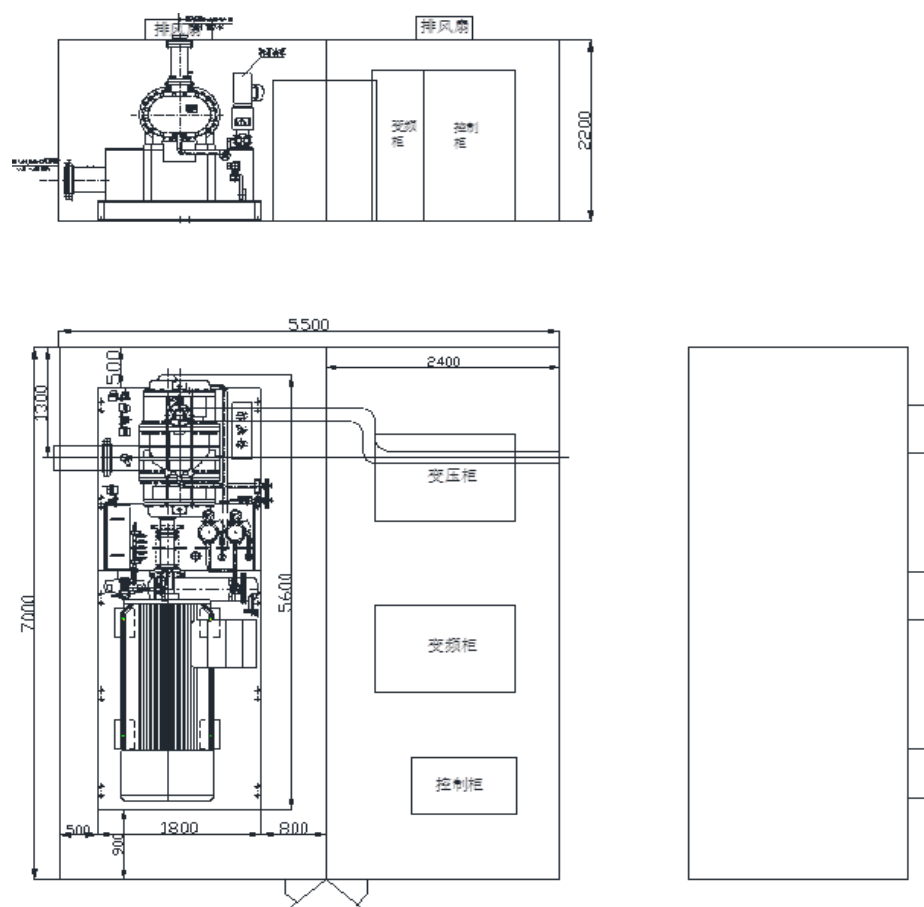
螺杆式蒸汽增压设备平面布置图
